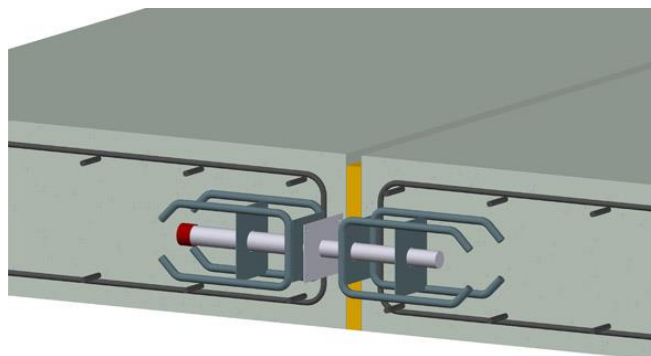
Conector para vigas (GEOCONNECT®, 2020)
